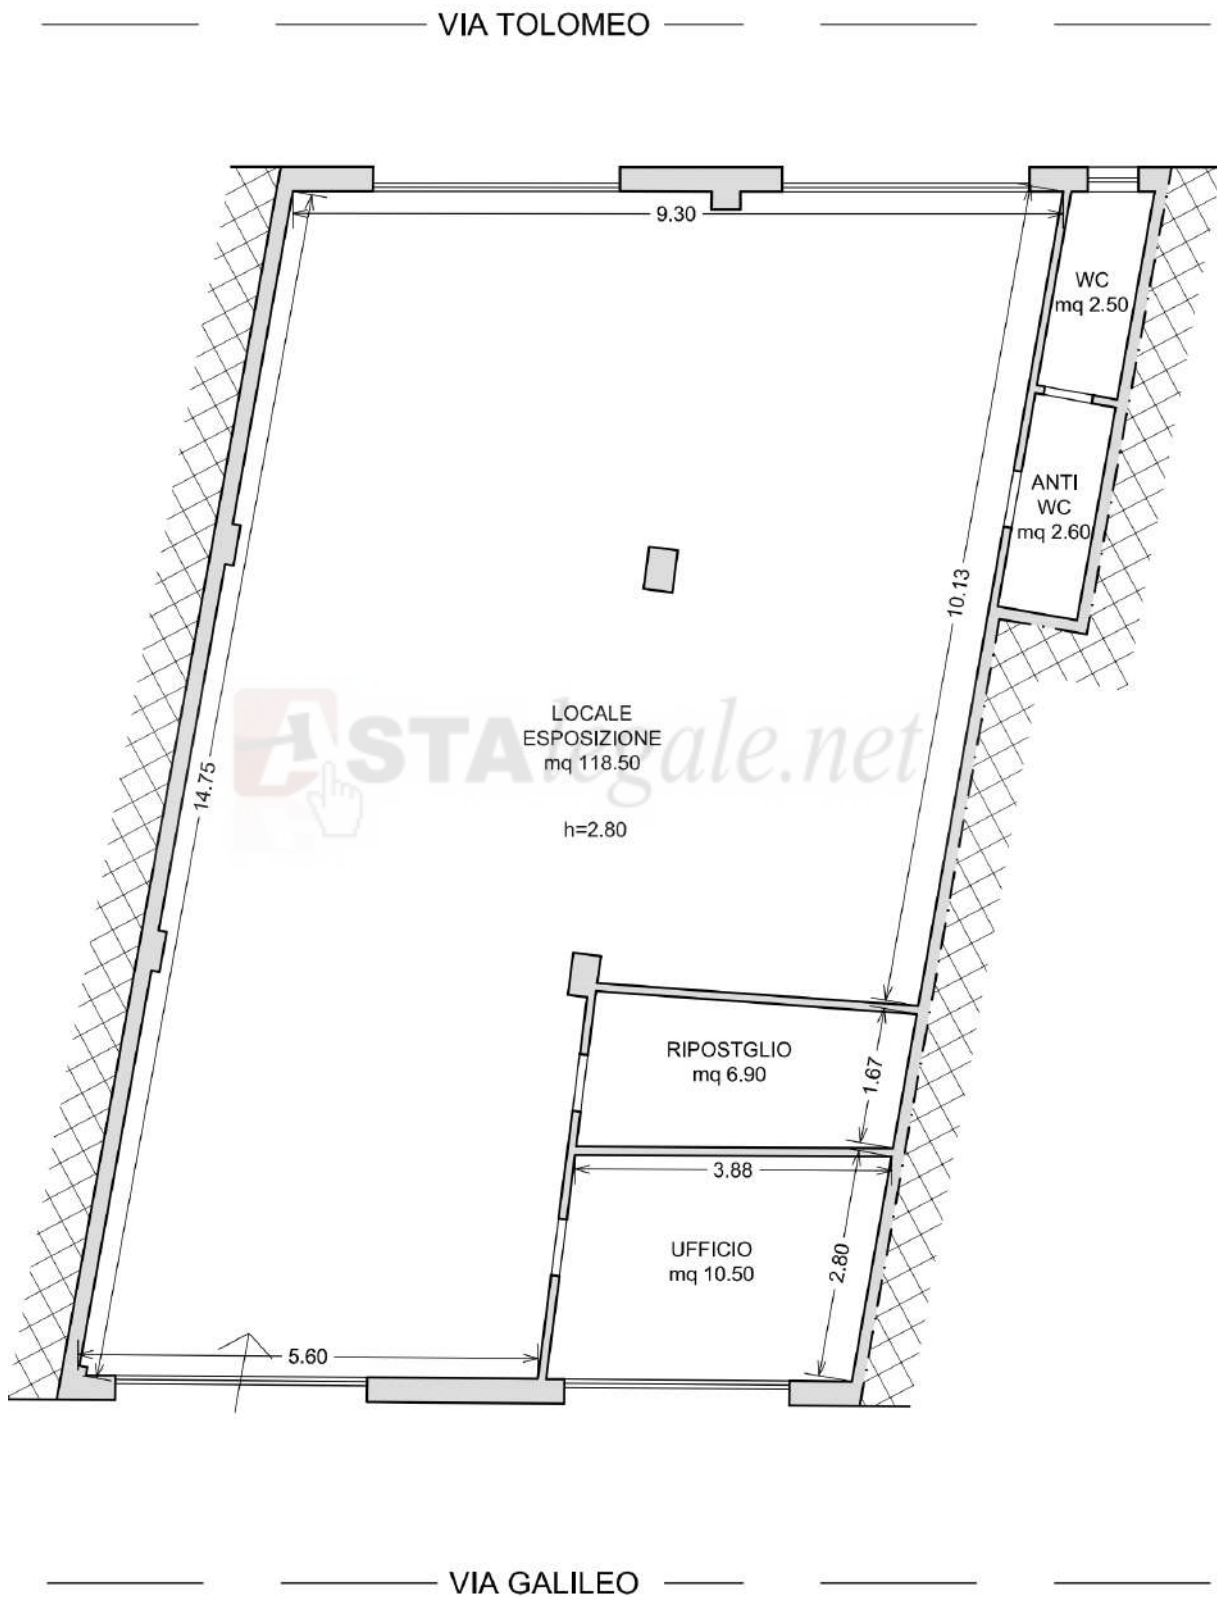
PIANTA PIANO TERRA - Sub 3.
